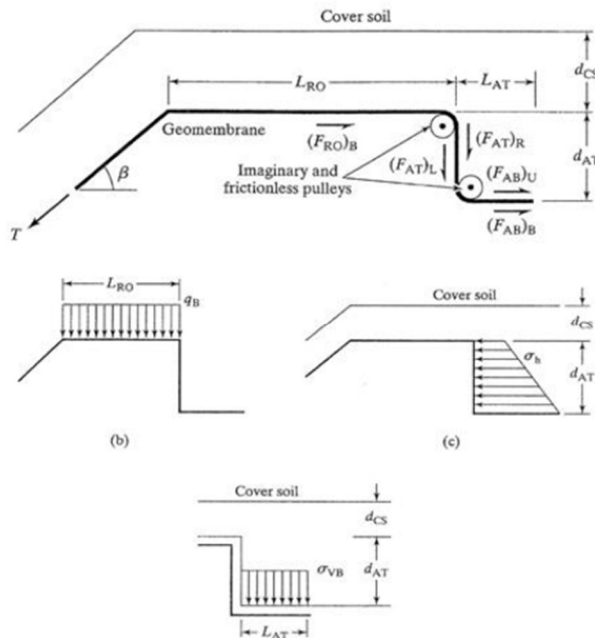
SCHEMA TRINCEA ANCORAGGIO.
